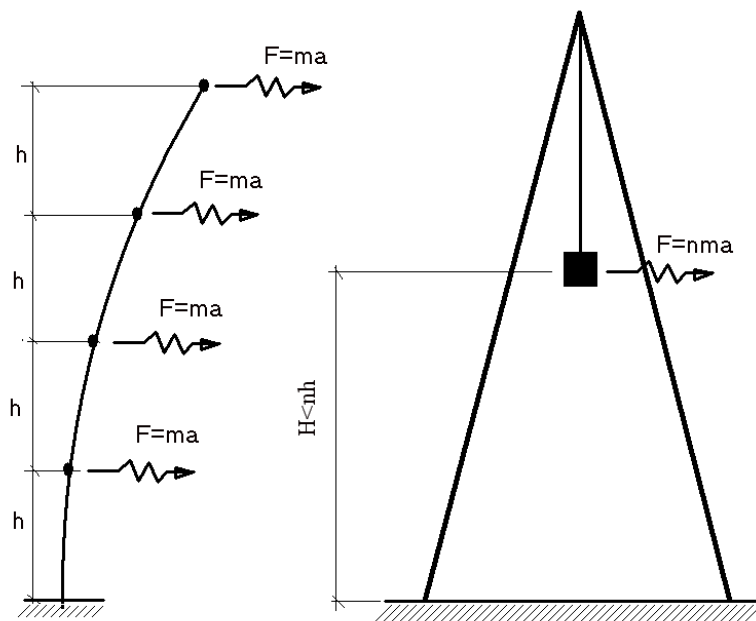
Динамические расчетные схемы здания: а) – традиционного консольного; б) – предлагаемого
